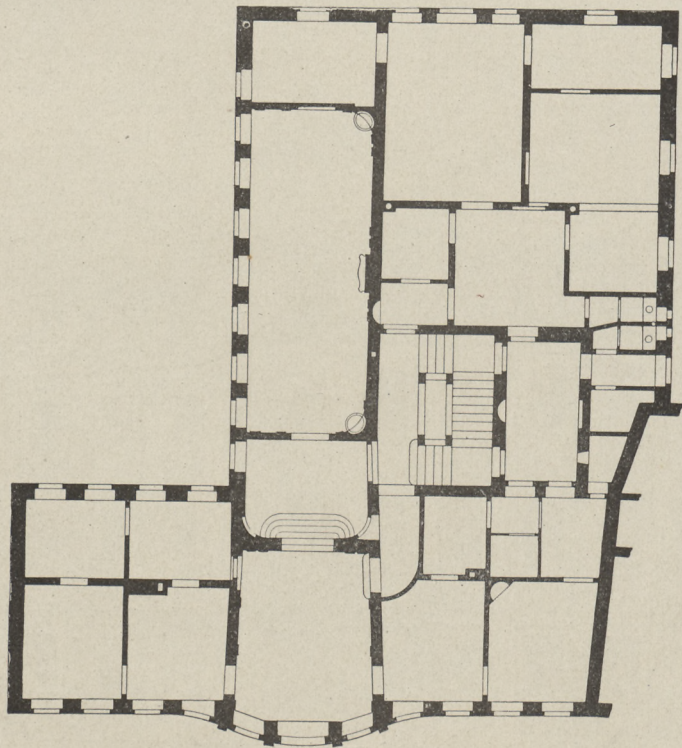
Boxberg'sches Palais. Grundriss des Erdgeschosses.
